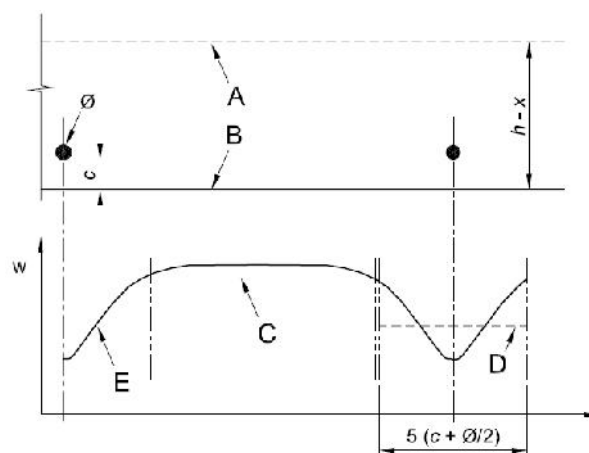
Ampiezza della fessura in funzione della distanza dalle barre
